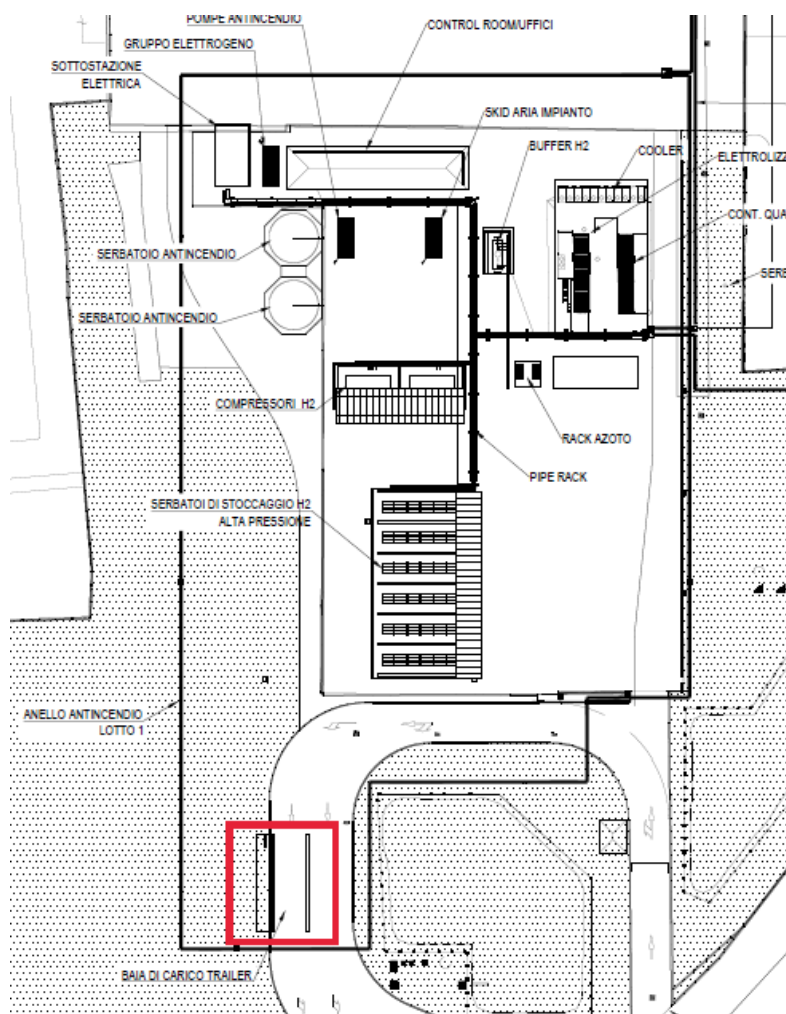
Individuazione planimetrica dei box per carro bombolaio nel Lotto 1
